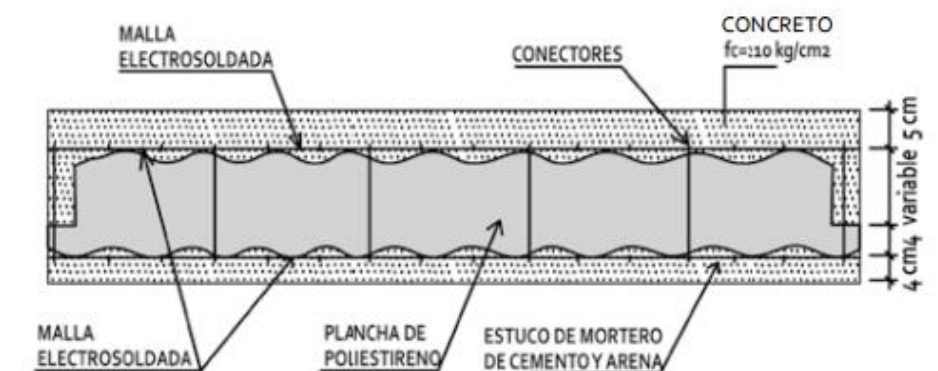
Otra Sección típica de panel PSM para muros estructurales
